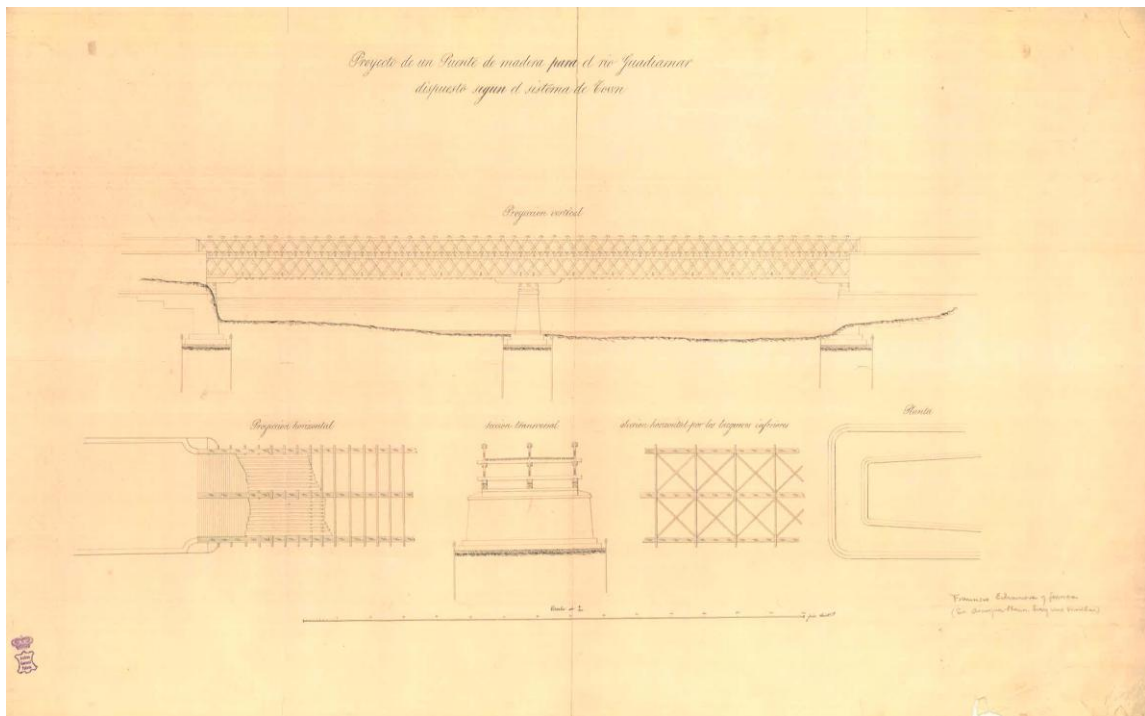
Proyecto de un Puente de madera para el río Guadamar dispuesto según el sistema de Town.
